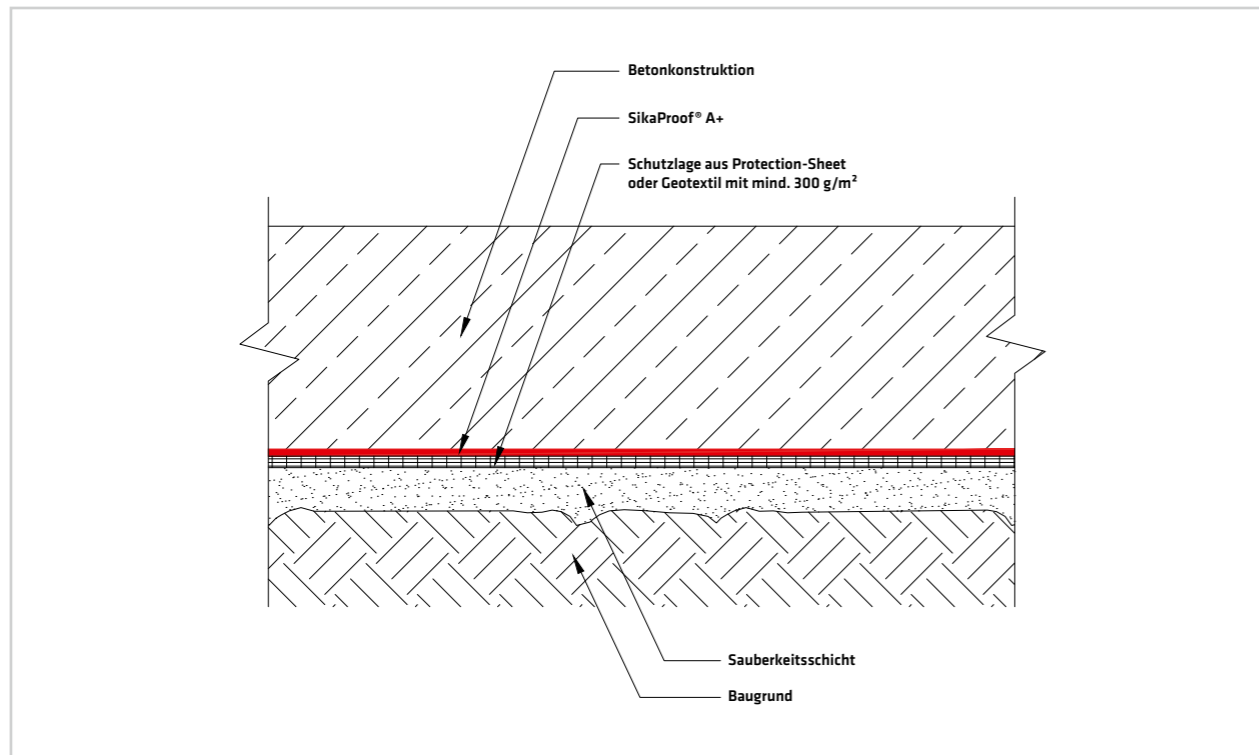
Verlegung auf Sauberkeitsschicht
